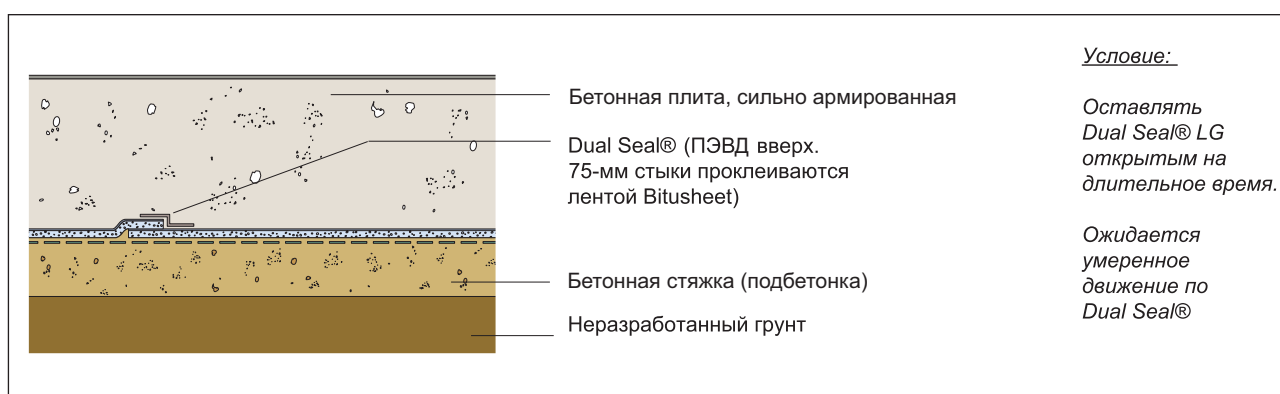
Бетонная плита с подбетонкой (см. также рис. 9)
